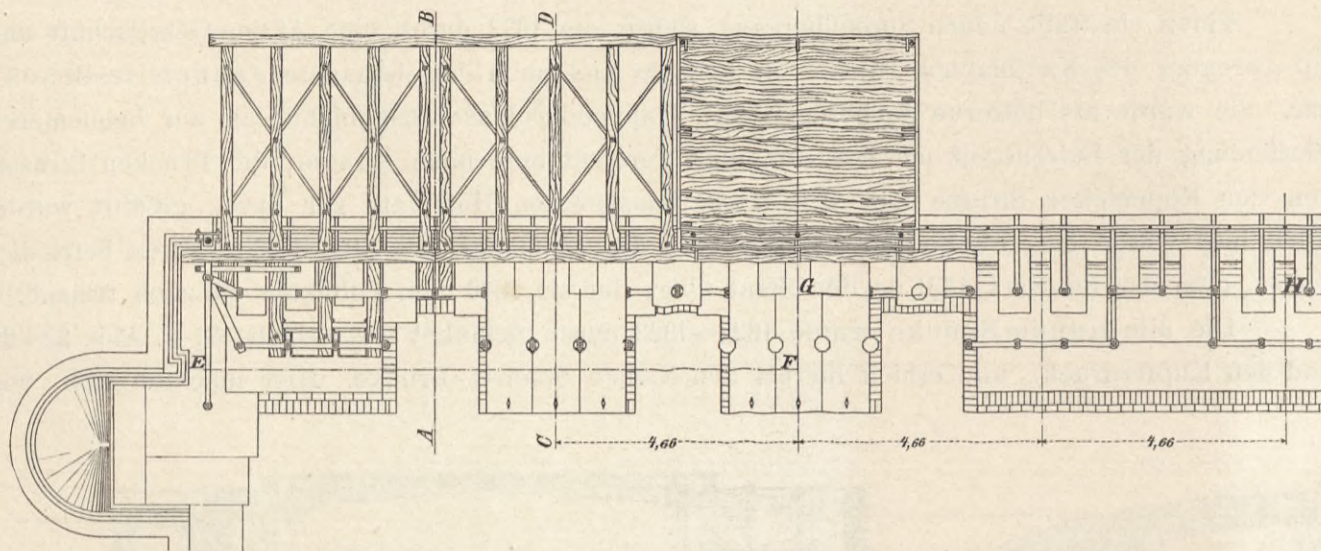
Grundriss der Schloss-Brücke.
